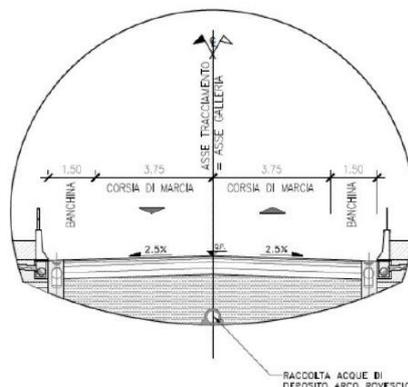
Sezione tipo stradale galleria Castellavazzo
